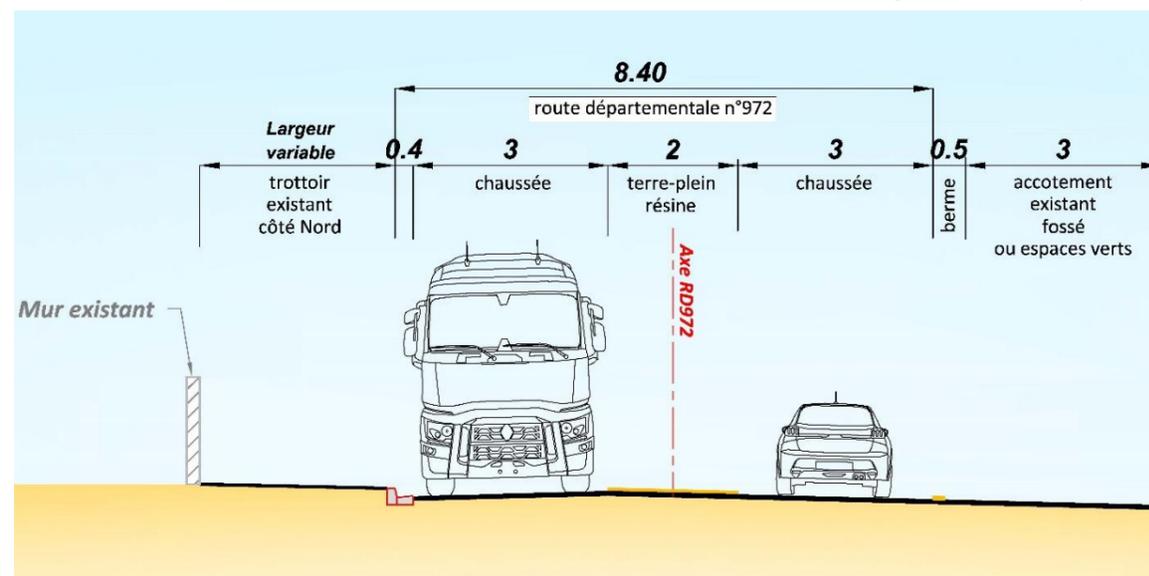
Profil en travers de la traversée de « La Chapelle »
